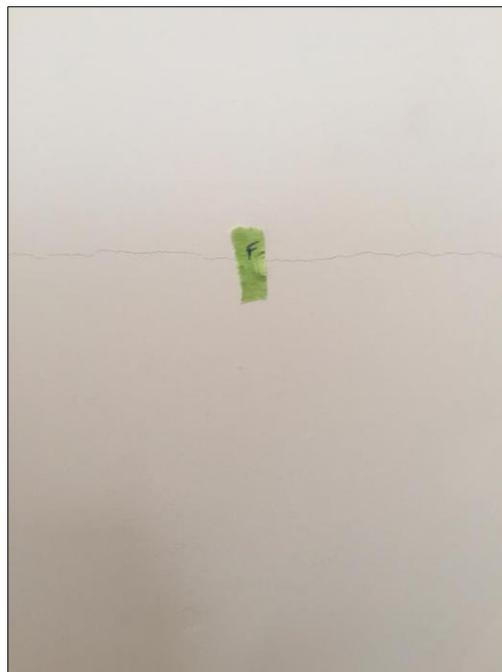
Fisuras por resanar en vivienda 60 de "Villa Los Nopales"
